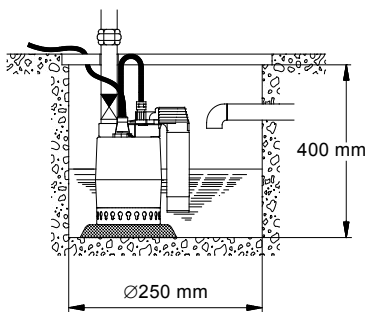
Mindestbehälterabmessungen für die Unilift KP-AV
